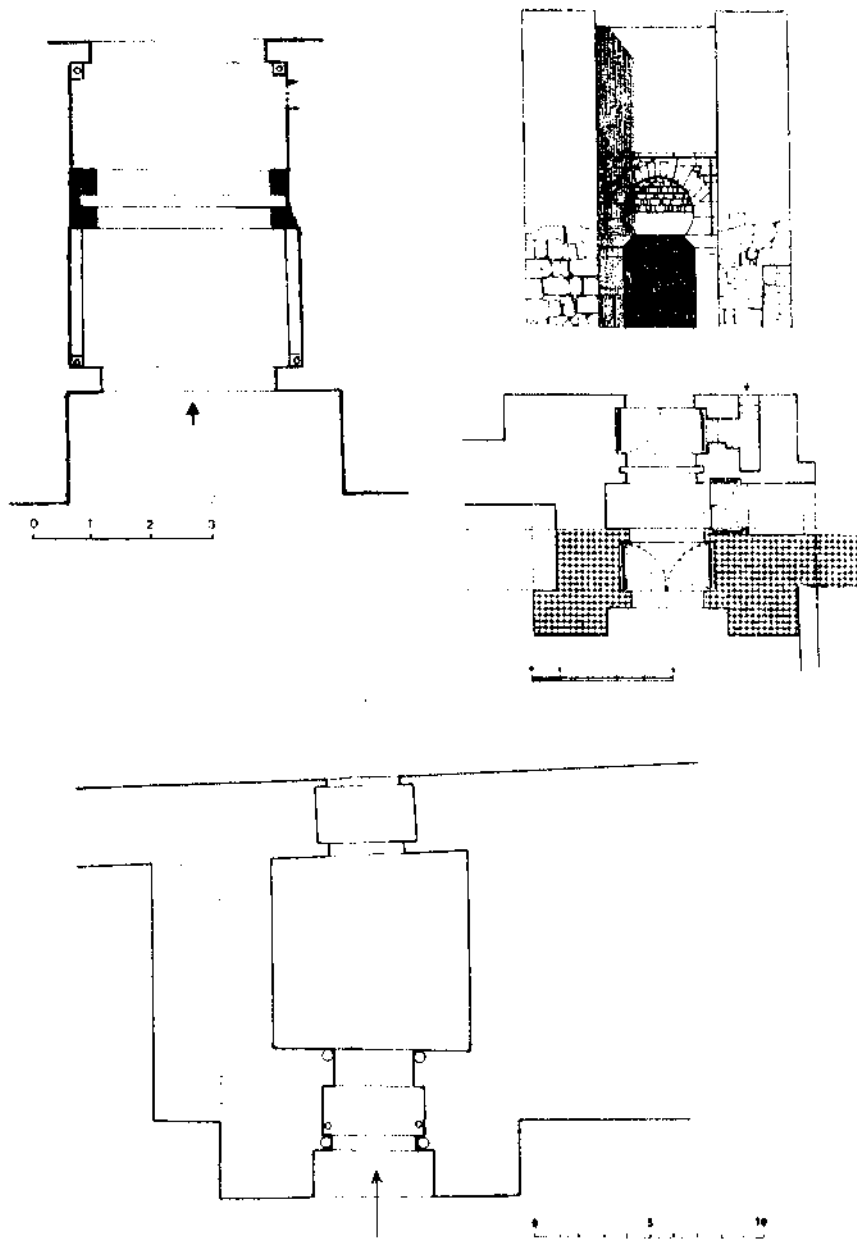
Puertas de Toledo. a) Bāb al-Mardūm, planta; b) Puerta de Bisagra Vieja; alzado árabe y planta (la trama indica la parte árabe); c) Puerta del Cambrón, planta.
